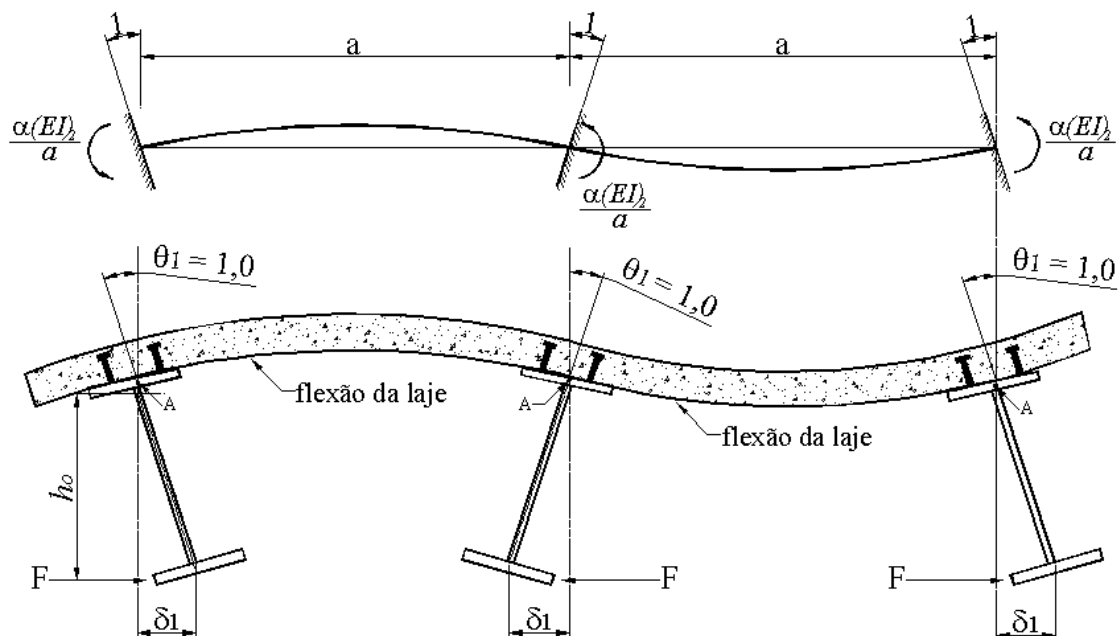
Rigidez à flexão da laje fissurada
